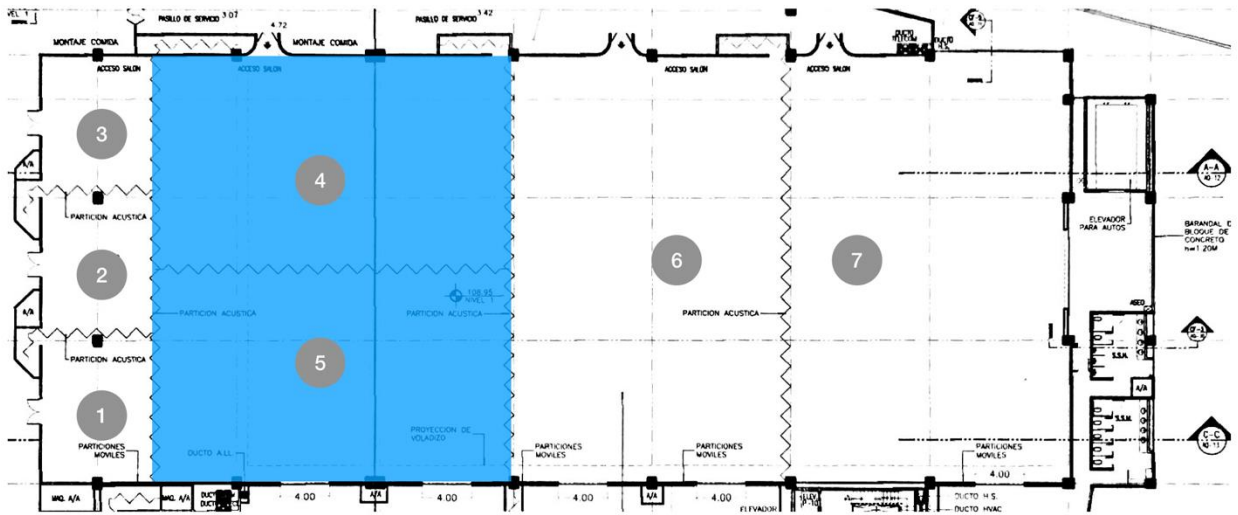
Planta arquitectónica de distribución de Salón Napoleón
